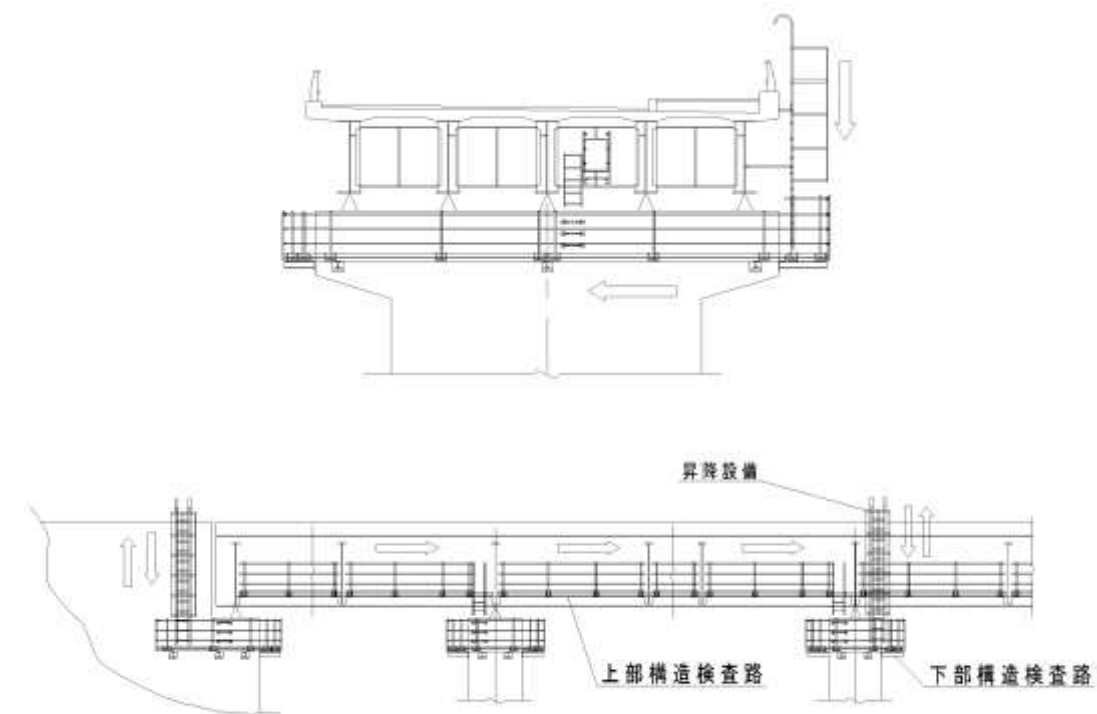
検査路設置計画と昇降設備設置計画の例
